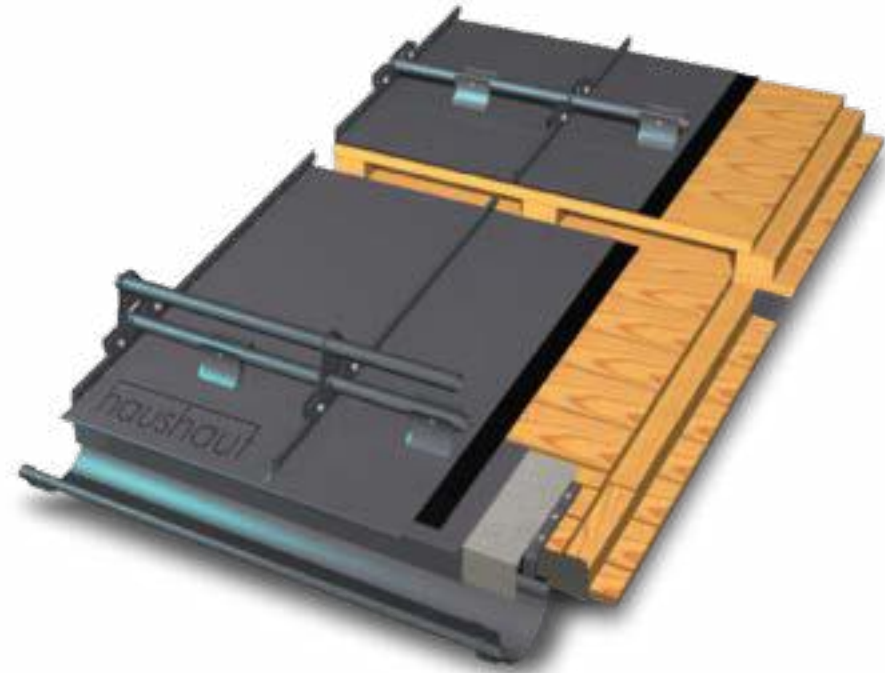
DETAIL TRAUFAUSBILDUNG VARIANTE 2
